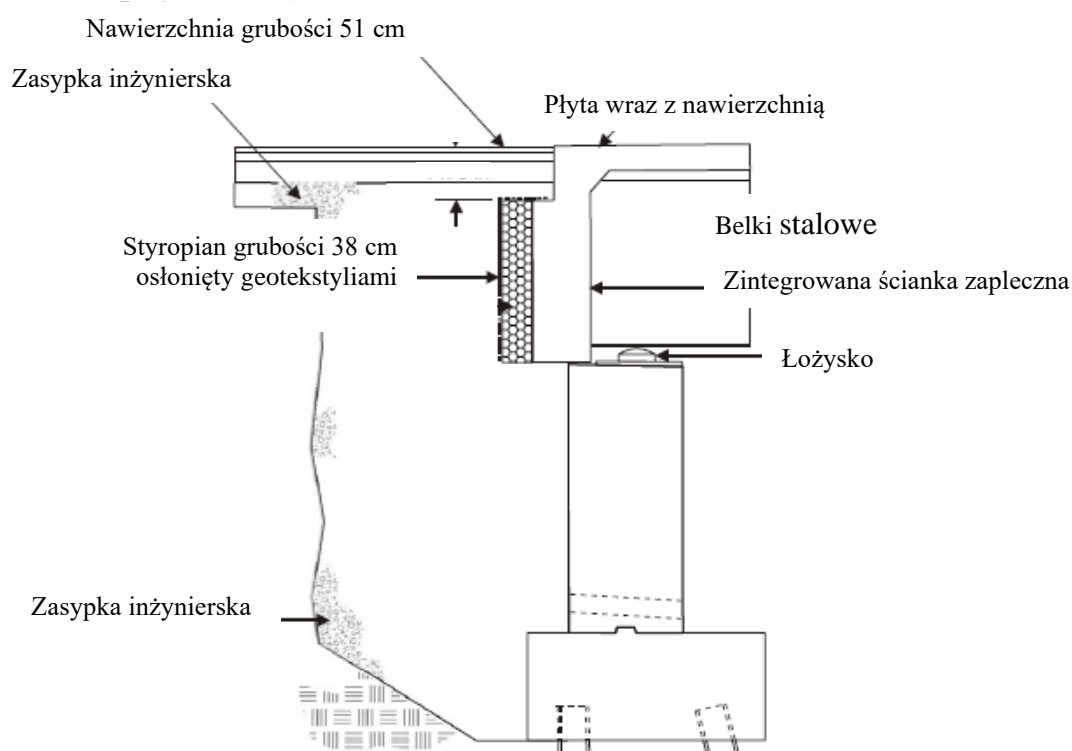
Szczegół płyty przejściowej - nawierzchnia betonowa [115]
